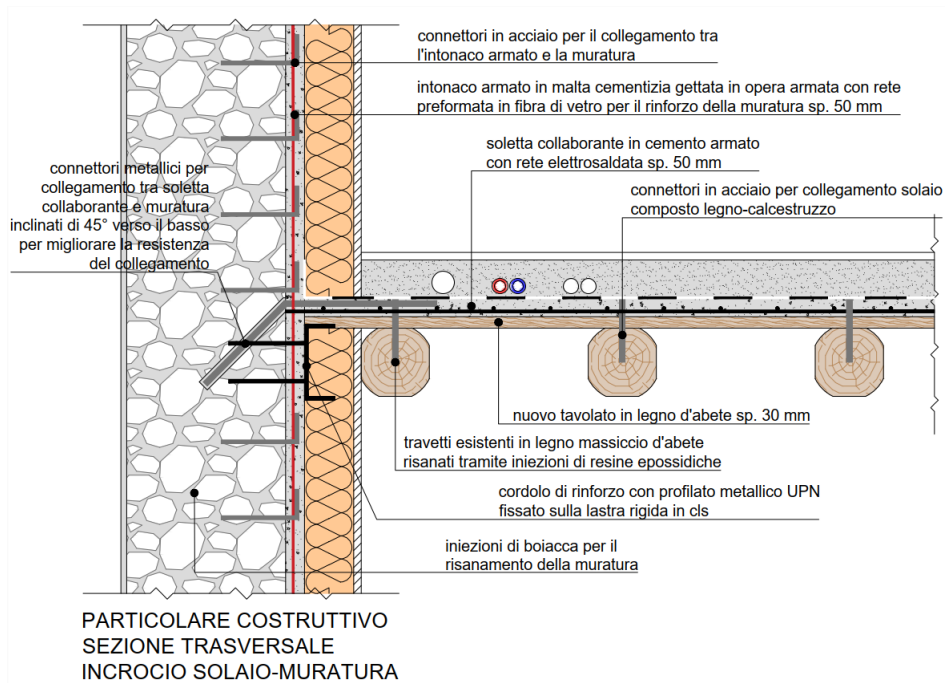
Particolare costruttivo incrocio solaio muratura – Sezione trasversale
